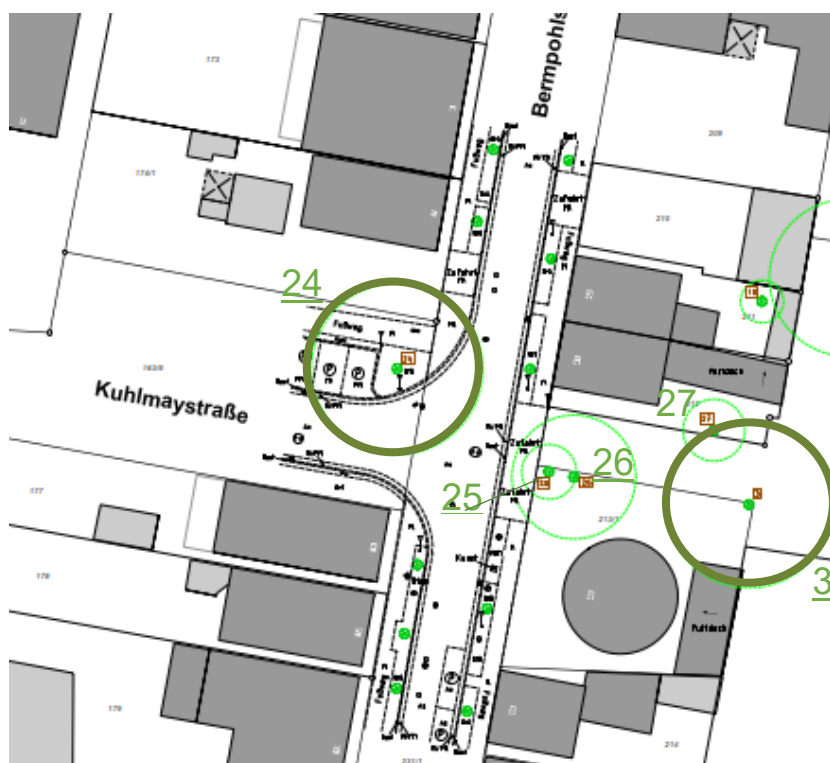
A. Ergänzung der Baumliste um Bereich der Bempohlstraße nach Einmaß Vermessungsbüro Horst (13.03.2023)
